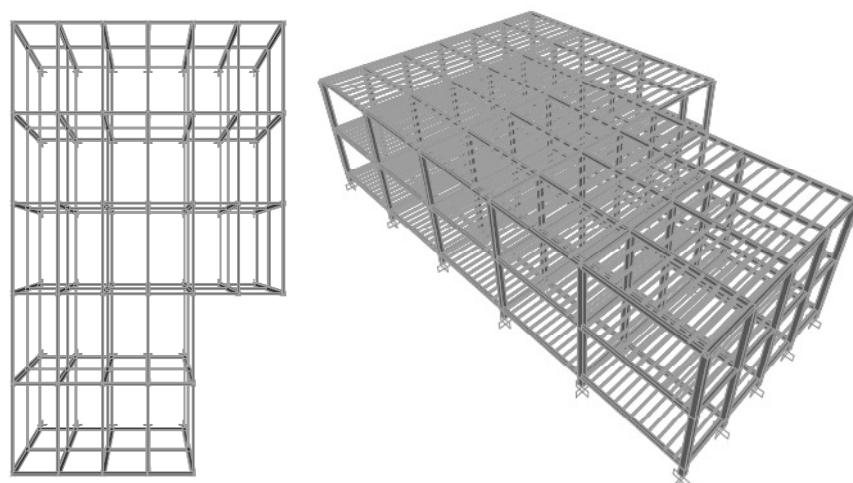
Vista superior e perspectiva da disposição estrutural 5[4I]+3[2I]
